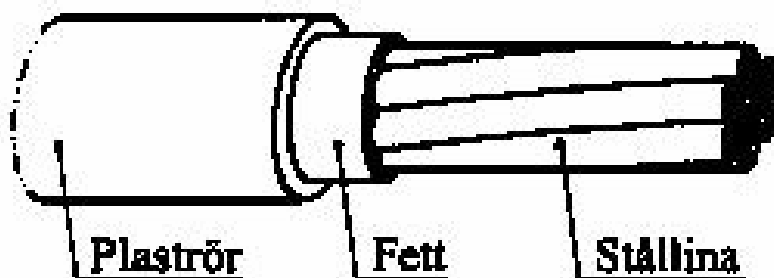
Olika konstruktionsprinciper för betongkonstruktioner.
